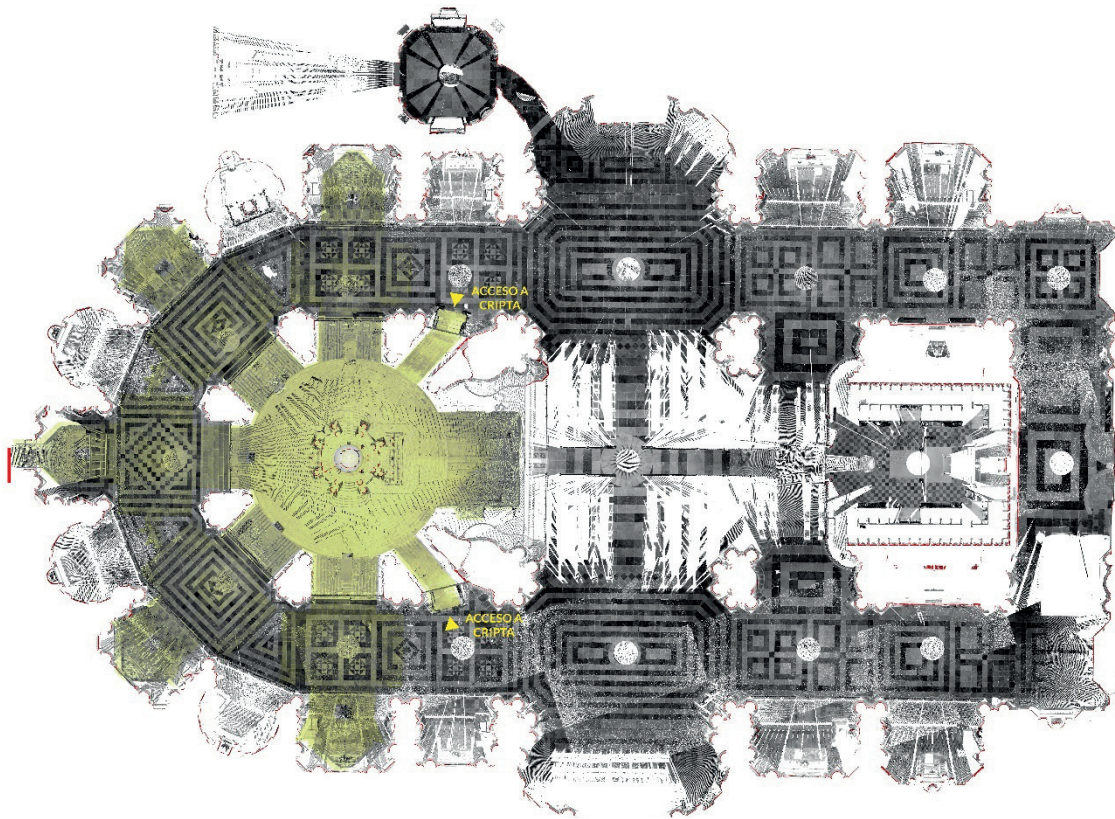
Ortofoto de la planta generada a partir de la nube de puntos, donde aparece superpuesta la planta de la catedral y la planta de la cripta. Fuente: elaboración propia
